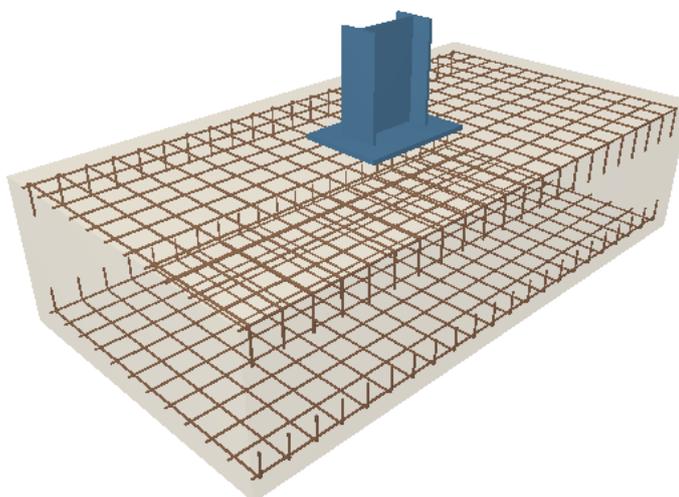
Zapata Z7. Fuente: CYPE 2017
